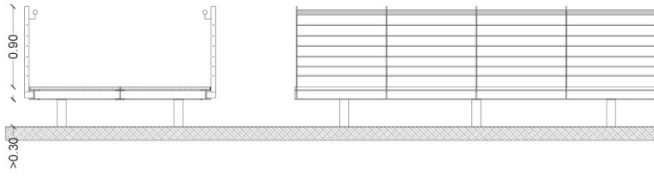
Querung Berufsschulzentrum Nord (Verkleinerung, Originalmaßstab Lageplan 1:1000)
